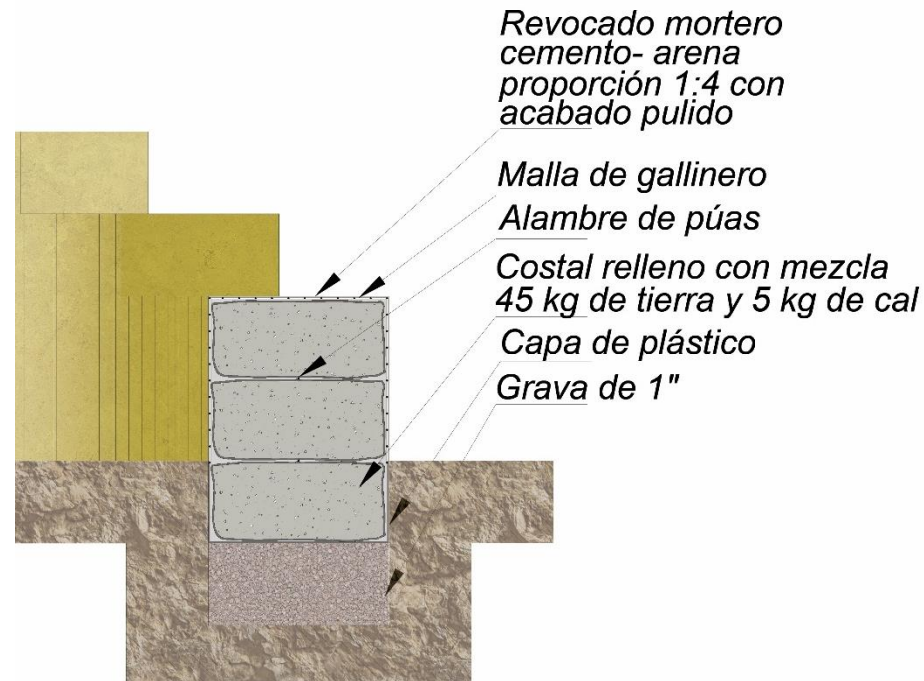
Detalle constructivo de superadobe. (Autoría 2017).
